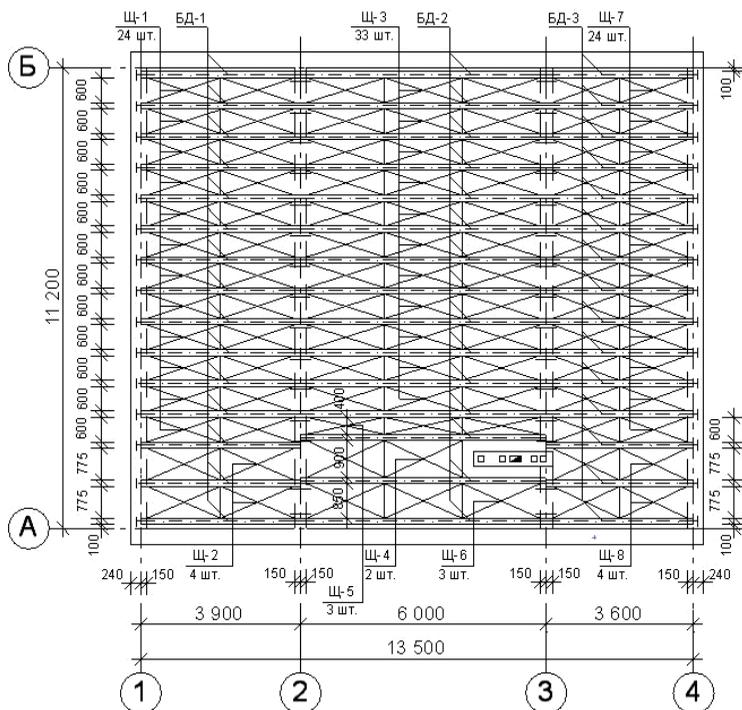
Пример оформления плана перекрытия по деревянным балкам
